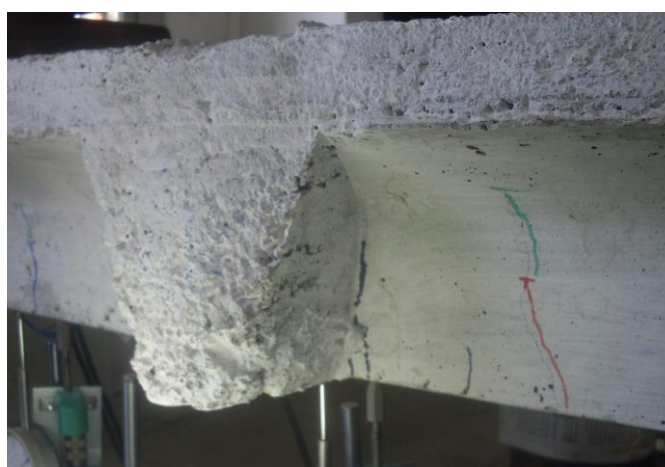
Aspecto das fissuras da viga V-2A, próximas à nervura secundária, para uma carga de 13kN
